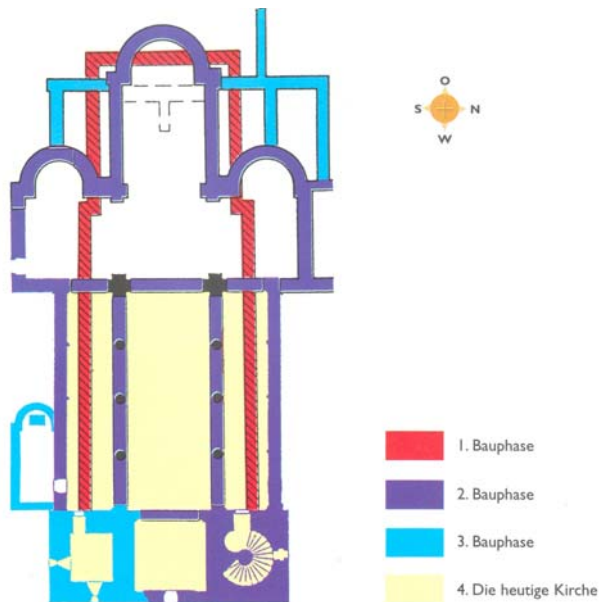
Hirsau, St. Aurelius, Grundriss/Baulterplan der ehem. Stiftskirche. Repro aus: Monrad, St. Aurelius Hirsau (wie Anm. 77)
